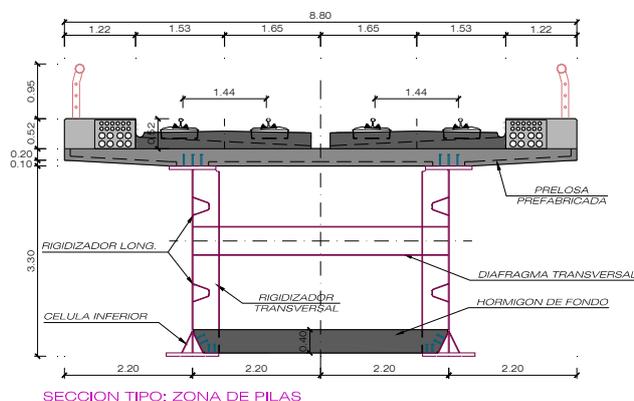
Sección transversal tipo de la estructura sobre el Río.
